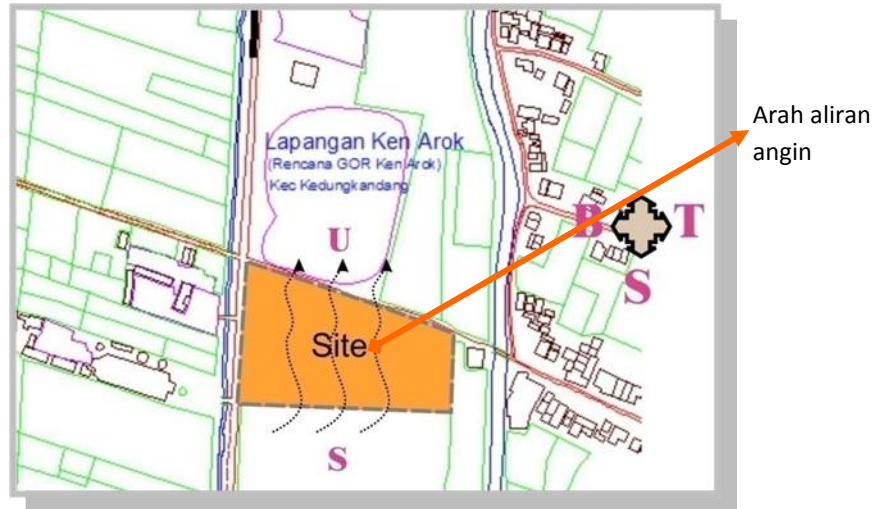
Analisa Orientasi Bangunan pada Site
